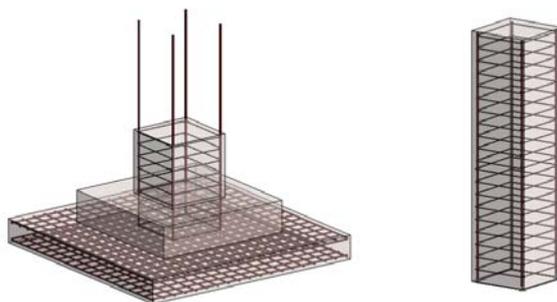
Модели монолитных фундамента и колонны с армированием
